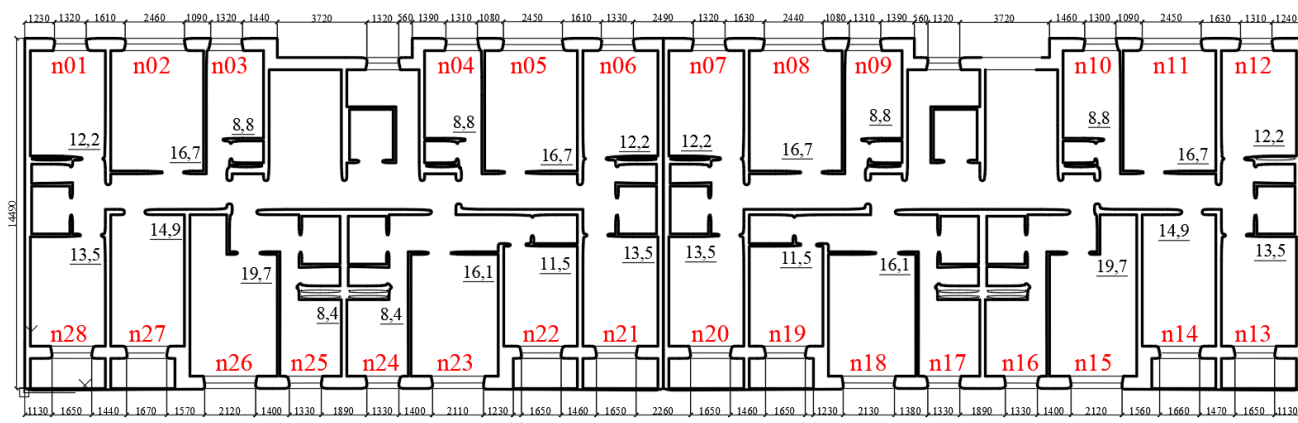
План типового этажа многоквартирного дома по ул. Квасова: n – номер этажа
